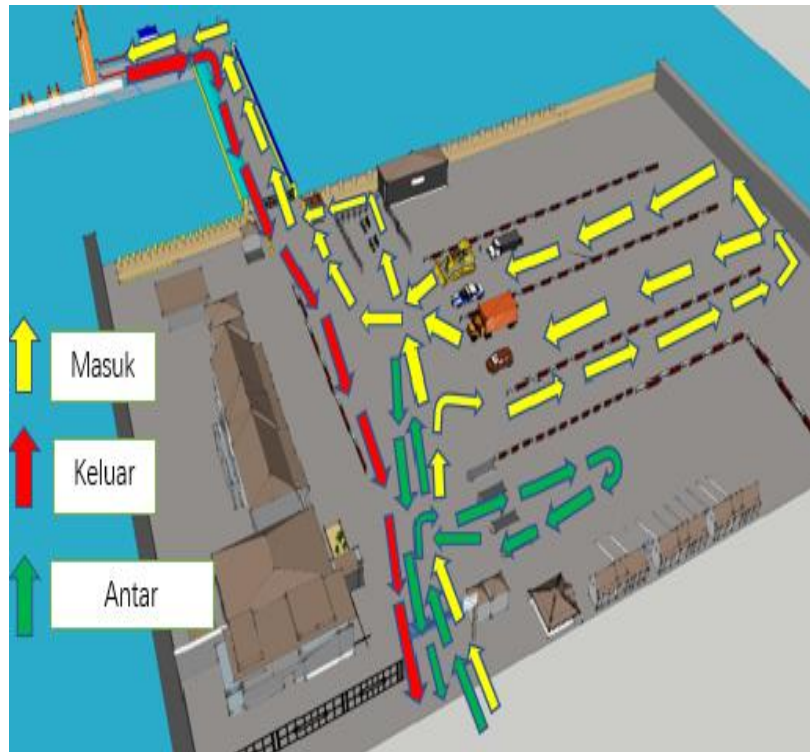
Layout Eksisting Pelabuhan Penyeberangan Sape
